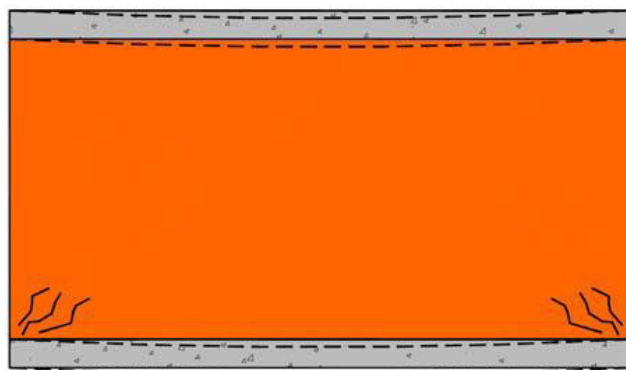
Fissuração devido à deformação semelhante entre o suporte e o elemento superior [14], adaptado de Lucas Carvalho, 1990
